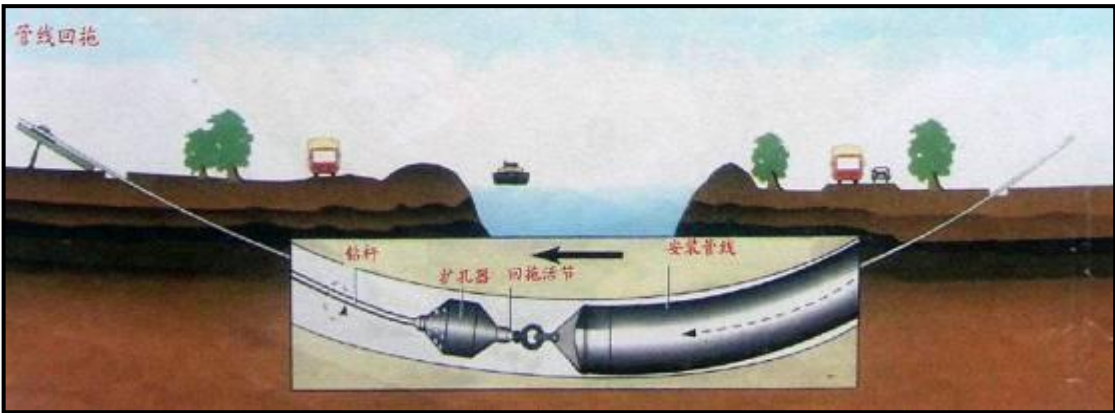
定向钻穿越施工管线回拖过程断面示意图
